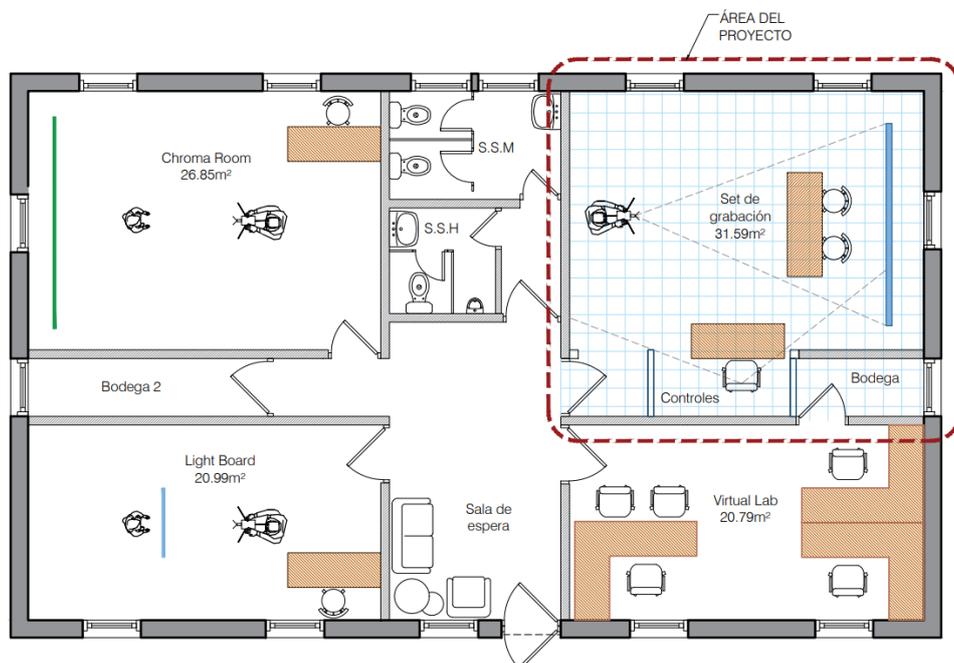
Planta arquitectónica-Centro de Educación a Distancia CED
